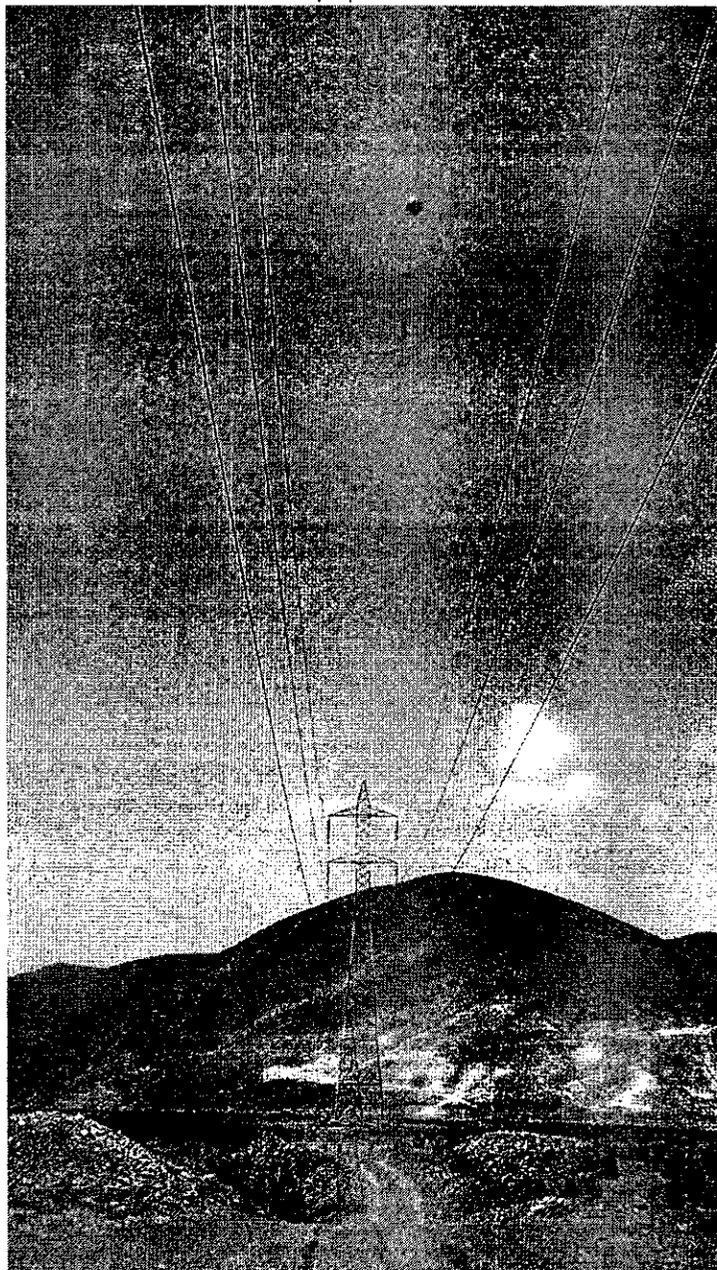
Salva pájaros en tramo Apoyo N°38- Apoyo N°39
